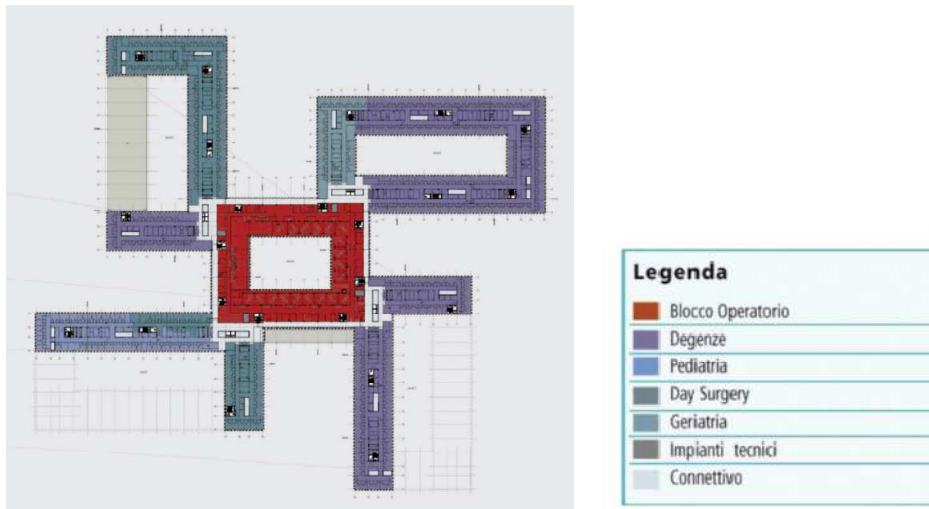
pianta del secondo piano. (Fonte: Baumschlager-Eberle Architekturbüro e FDA Architecten & Ingenieure).
